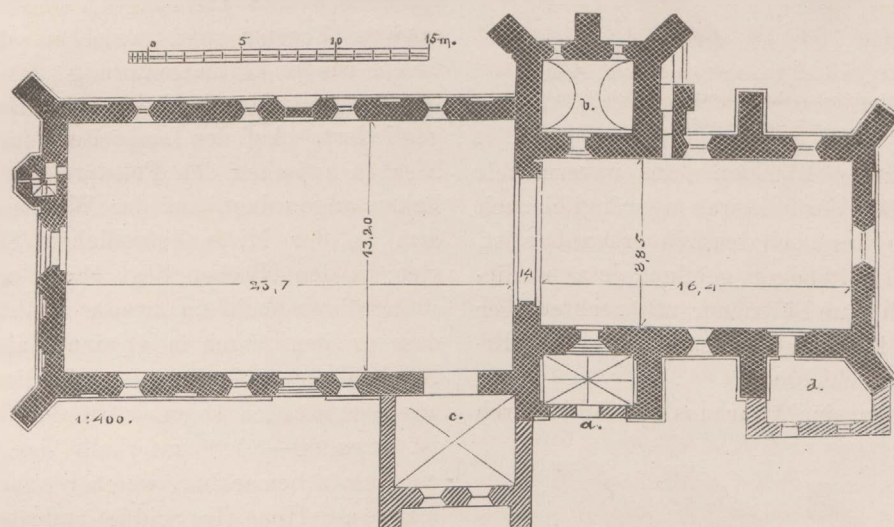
Rehdien. Grundriss der kathol. Pfarrkirche.
